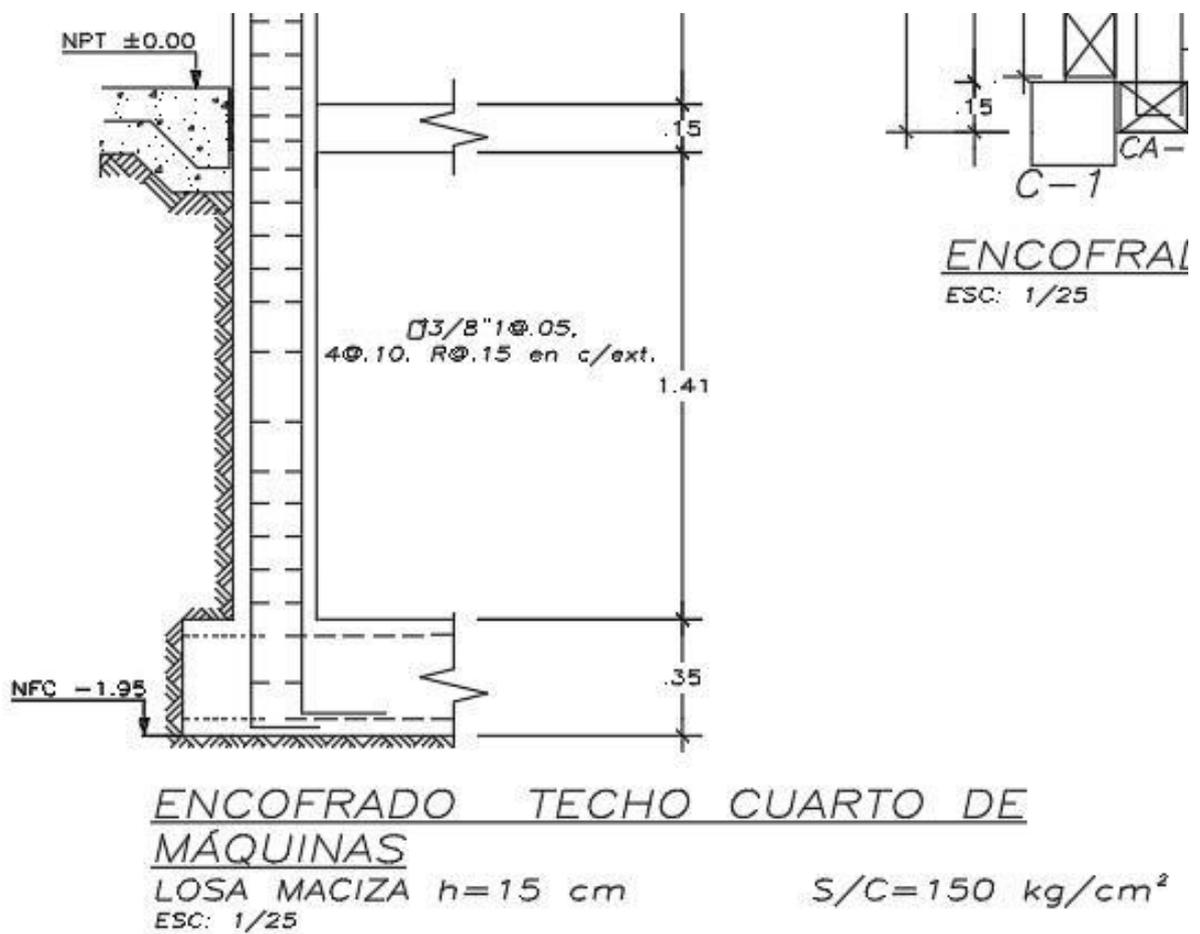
Detalle de encofrado techo cuadro de máquinas del plano E – 15 (incidencia 07)
